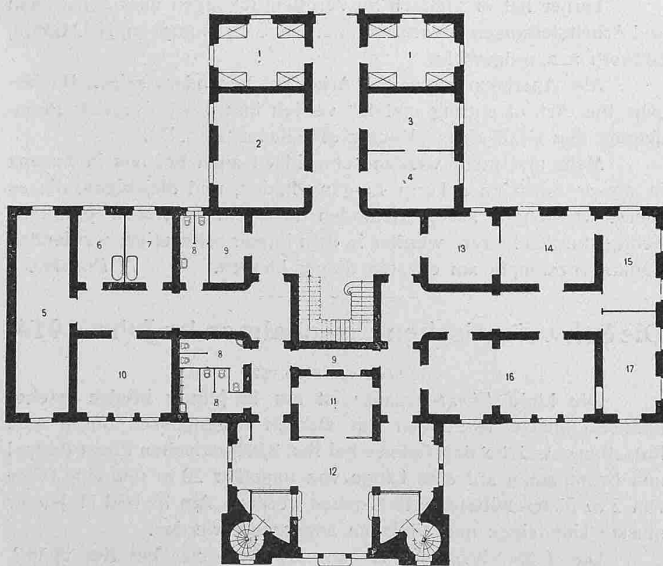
Grundriss vom Erdgeschoss.
